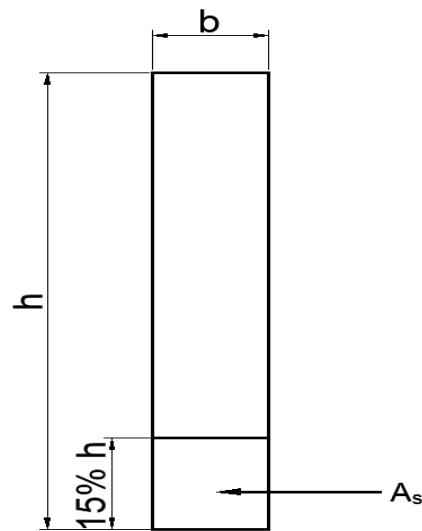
Armadura de tração para vigas-parede bi-apoiadas.
